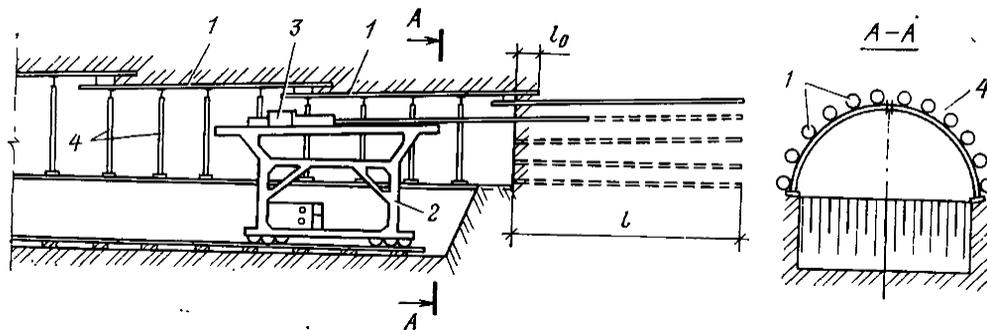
Схема устройства экрана из труб из забоя выработки: 1 – экран из труб; 2 – буровая рама; 3 – бурильный молоток; 4 – арки
